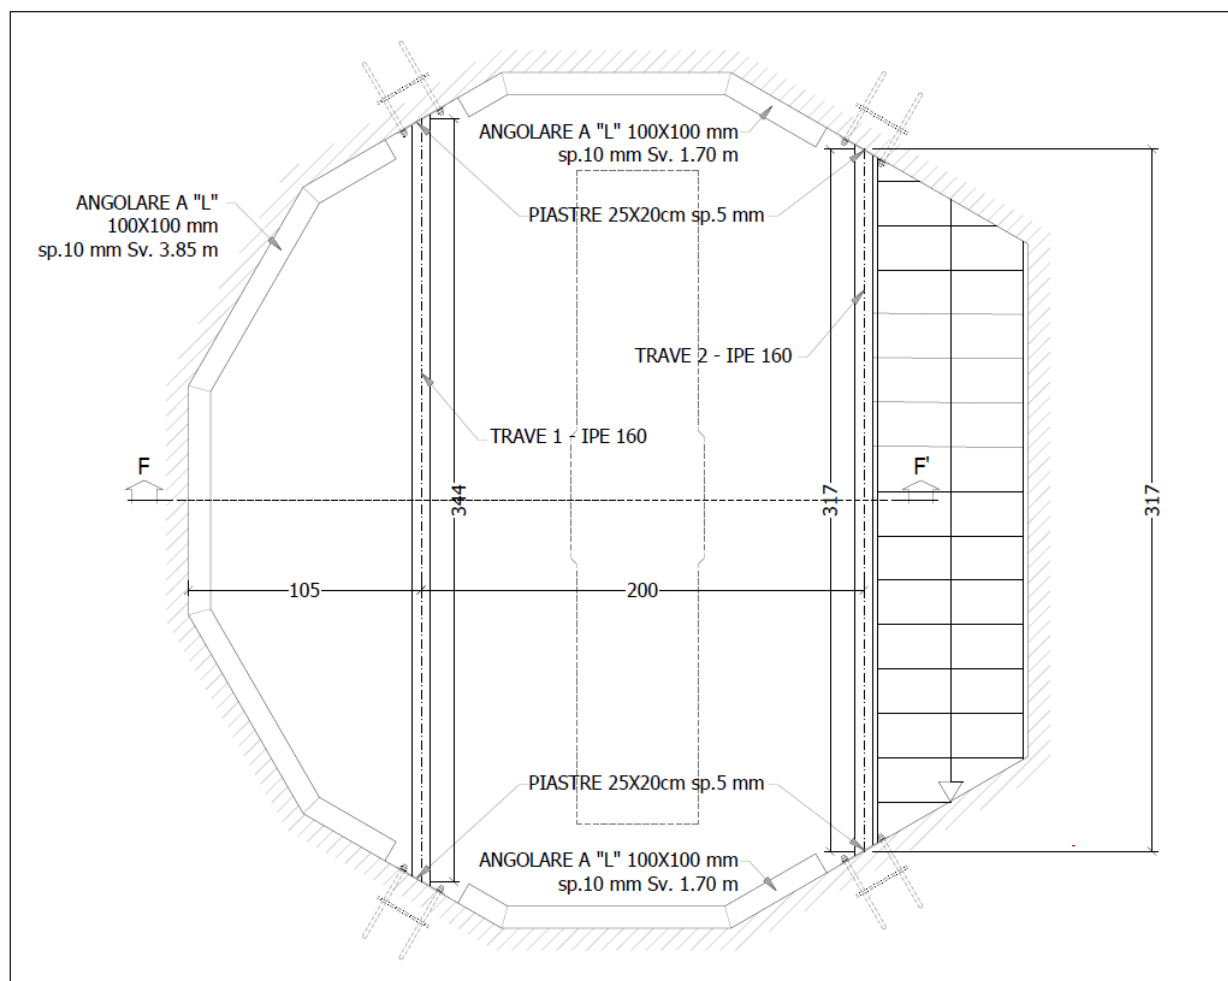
TELAIO IN ACCIAIO, PIANTA A QUOTA +396.00
